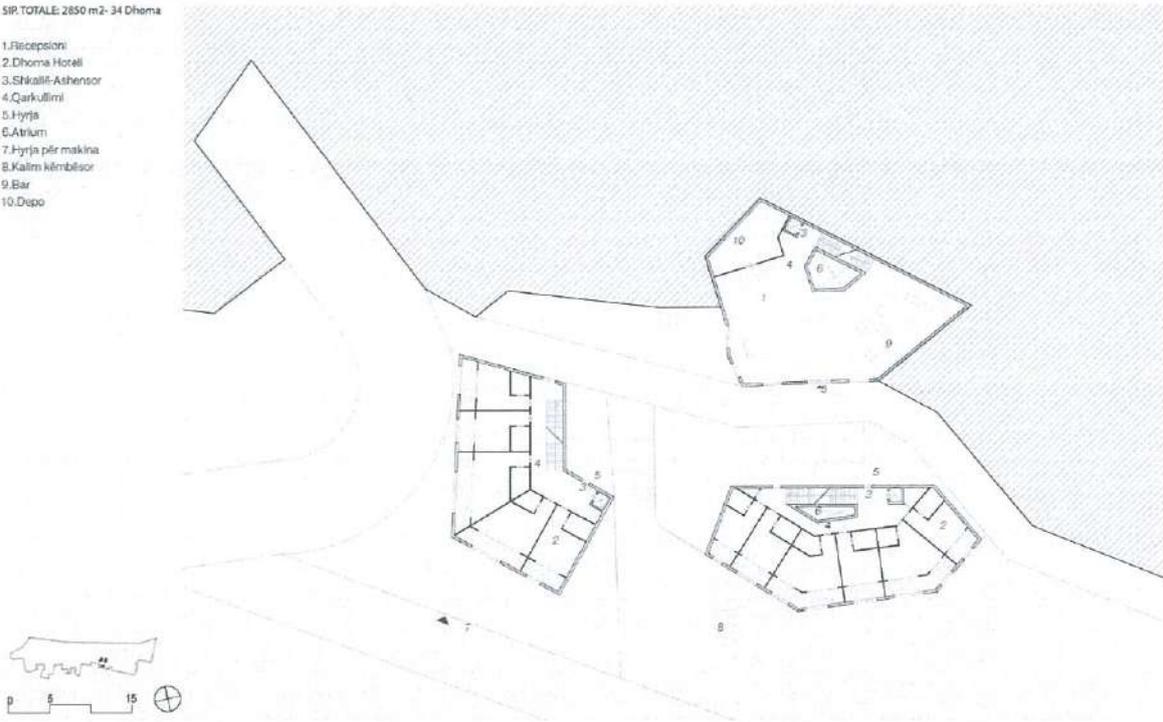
Plani i Katit Përdhe të Hotelit me 3
